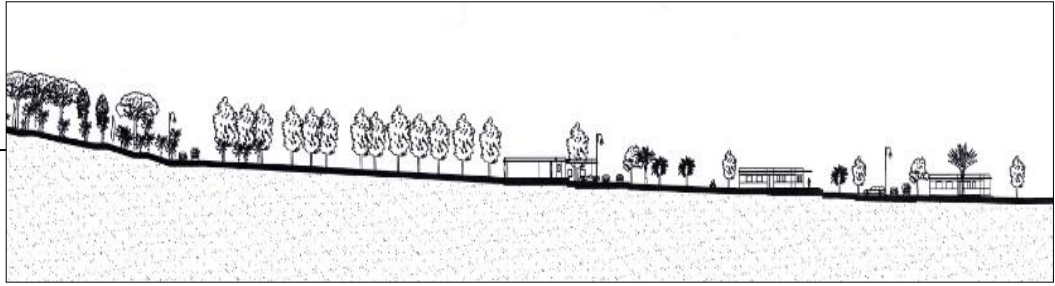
coupe sur bungalows et jardins méditerranéen
